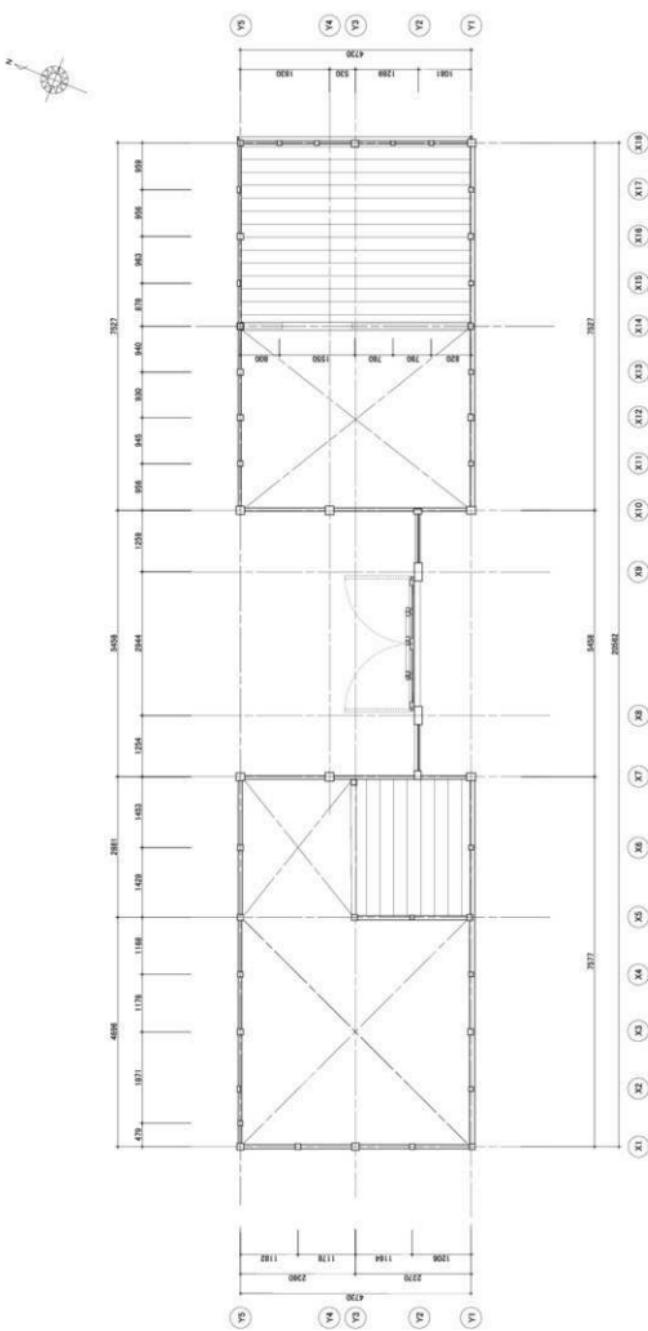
長屋門 竣工 2階平面図 5=1/100
